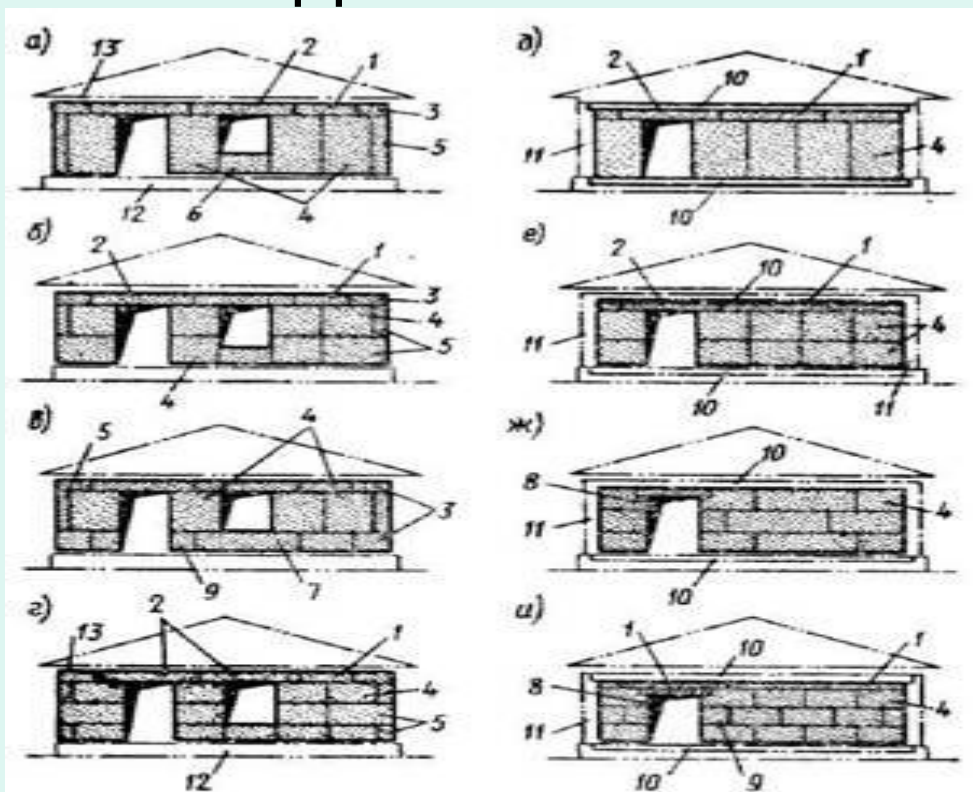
Схемы разрезки стен одноэтажных жилых зданий на крупные блоки:
